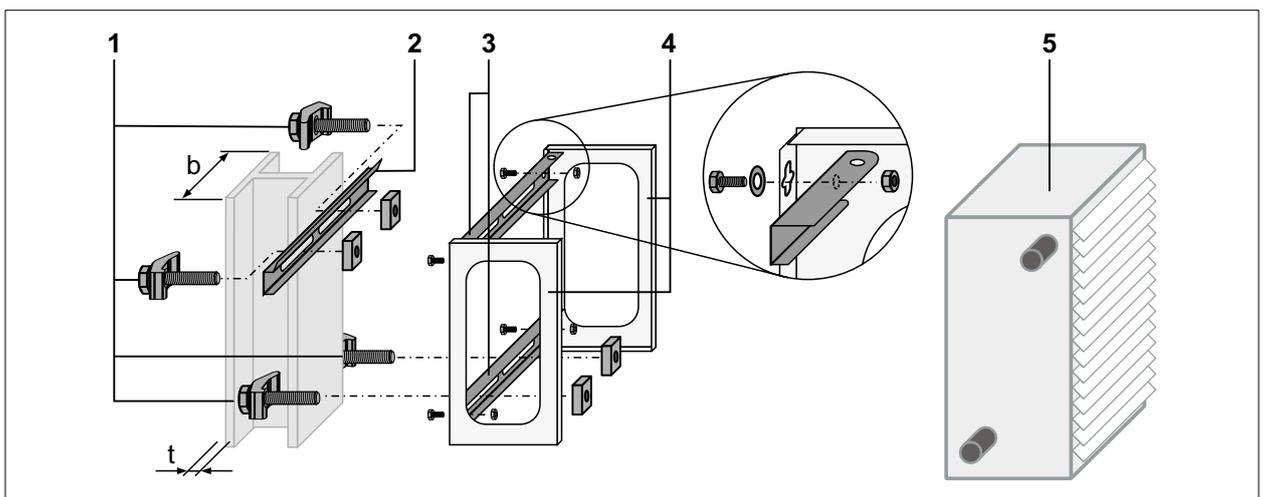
Montaje del aerotermo con el juego de fijación en la viga de acero
